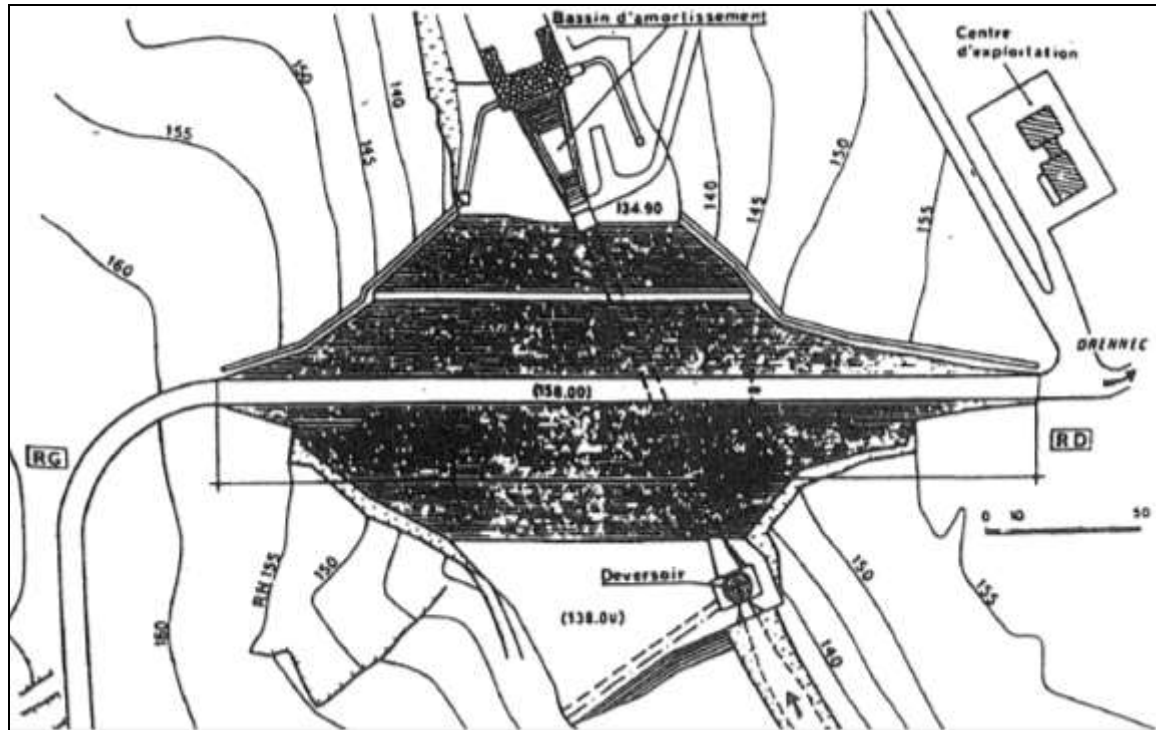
Vue en plan du barrage (sce: EPTB Elorn)
